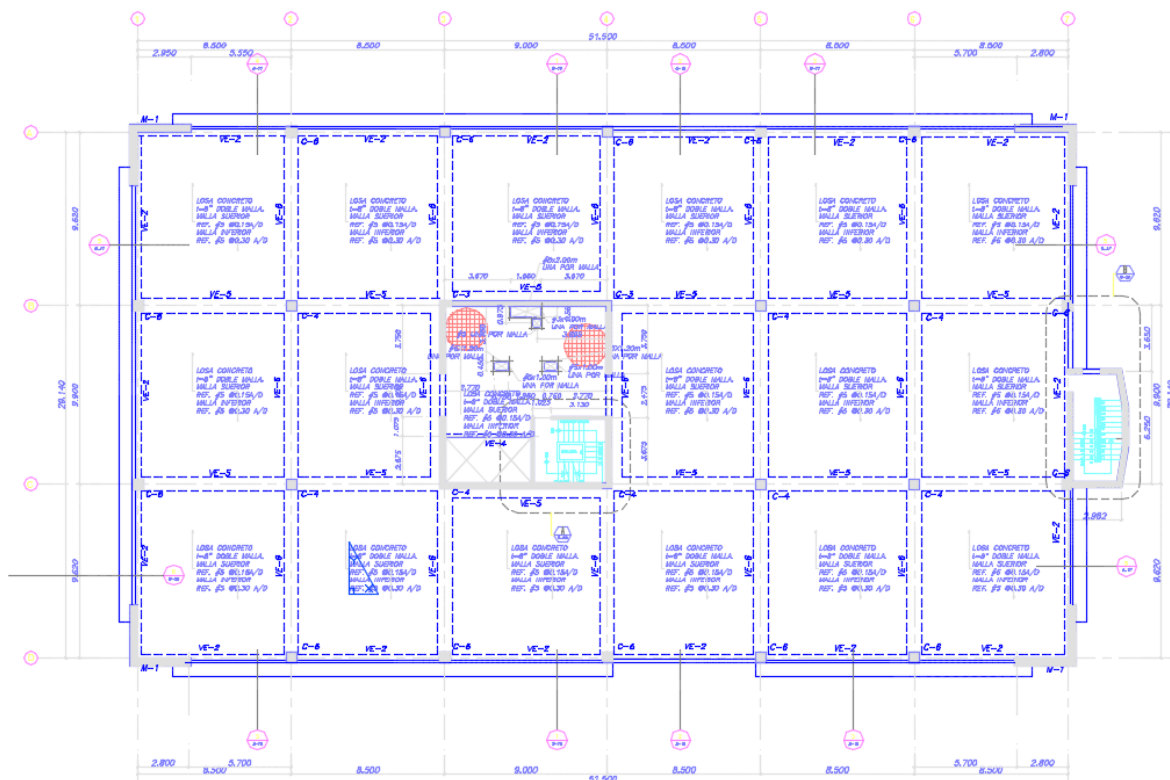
Planta Estructural Entrepiso, Tercer Nivel.
